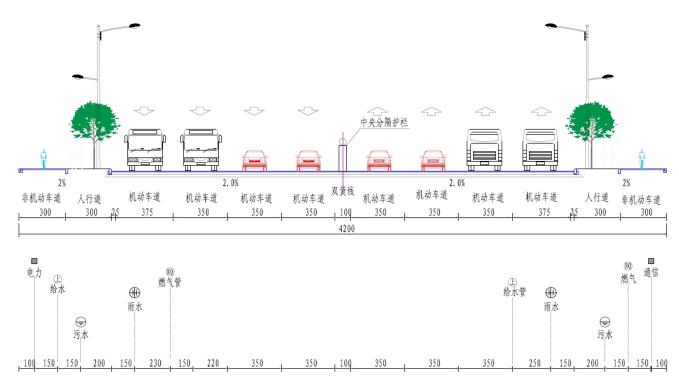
管线综合横断面图(道路宽度≥40m)
